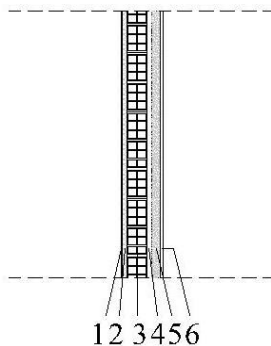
Planimetría EP de tipología de paramentos verticales. Fuente: Elaboración propia.
